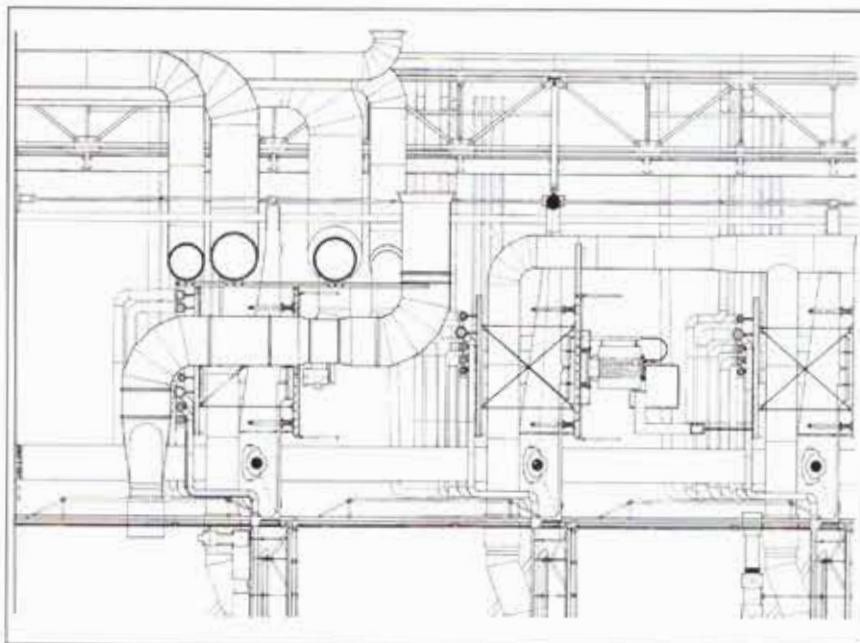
Renzo Piano, Sezione trasversale, particolare dell'intercapedine sul fronte est del centro Georges Pompidou "Beaubourg", Parigi 1971-77.
